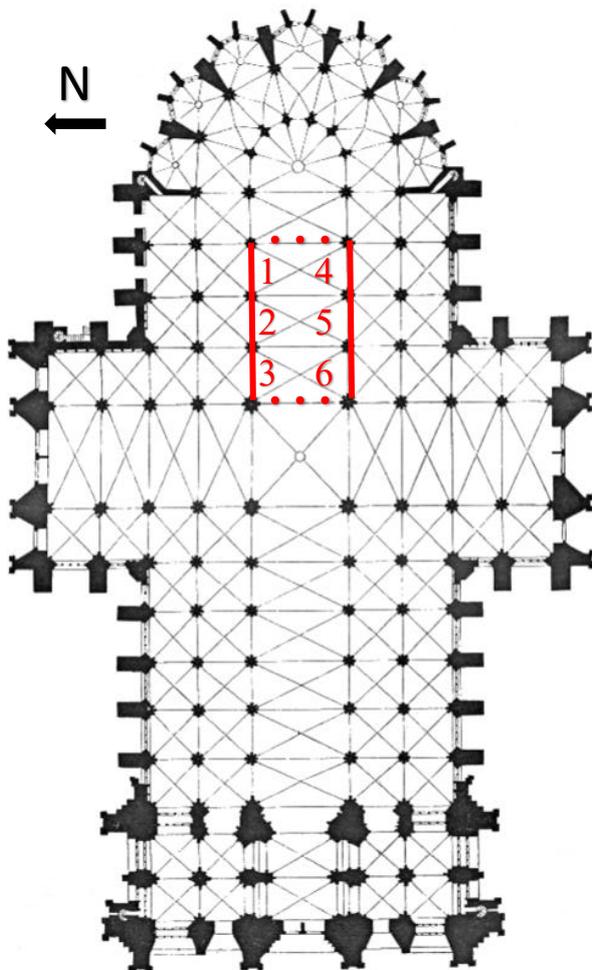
Kölner Dom, Grundriss geostet [1]
